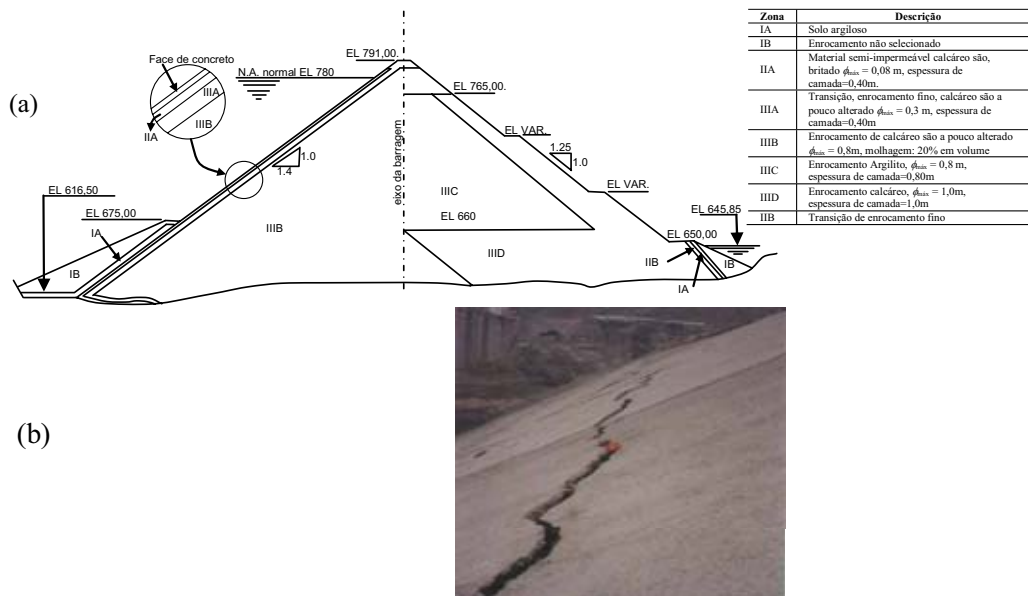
Barragem de Tianshegquiao I (178 m): a) Seção típica; b) vista da trinca desenvolvida no maciço antes da construção da face de concreto (Mori, 1999).
